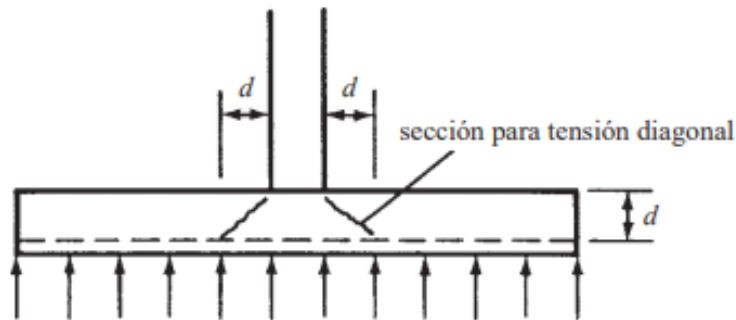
Mecanismo de falla por corte en zapatas. Modelo de grietas en 45° (McCormac, J. 2011).
